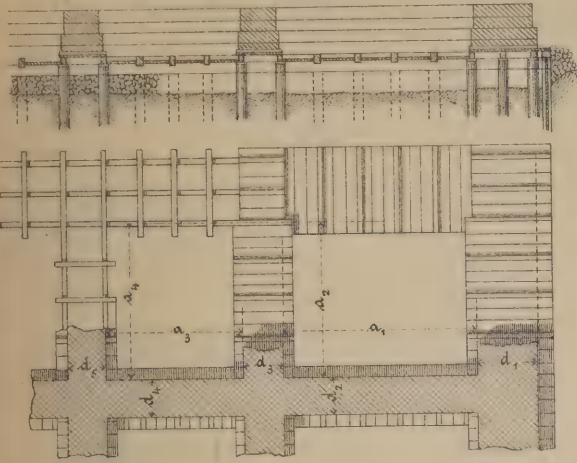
Fig. II Pfahlrost unter d. Widerlager einer (schiefen) Brücke mit geraden Flügelmauern.
